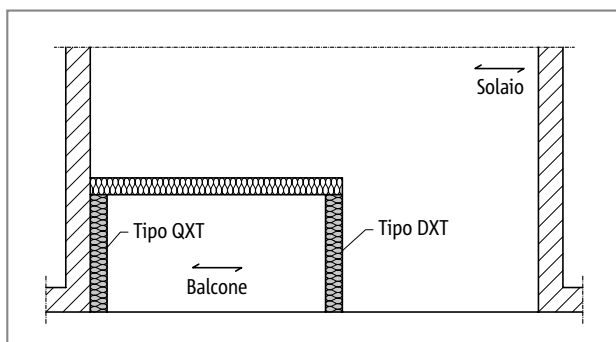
Schöck Isokorb® tipo DXT, QXT: solaio monodirezionale
